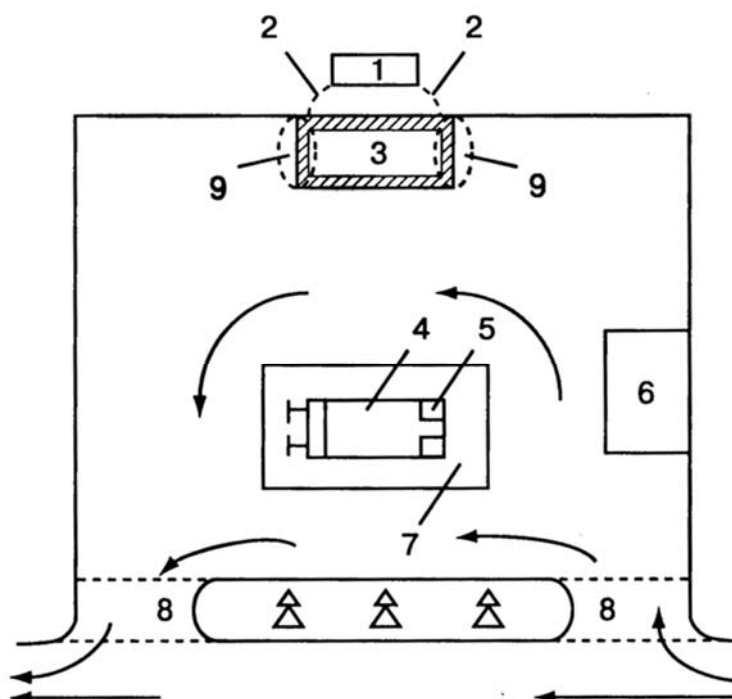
Схема планировочного решения АЗС блочного типа с подземным расположением резервуаров и ТРК над ним
